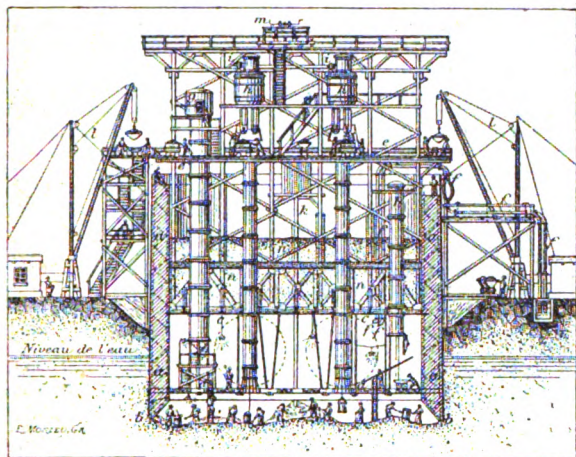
Sezione verticale del pozzo Steinwerder durante il lavoro di affondamento: *a*, rivestimento del pozzo; *b*, estremità di avanzamento del pozzo; *c*, fondo delle casse per la sabbia; *d*, ponte di lavoro; *e*, piccola ferrovia per vagonetti; *f*, condotte d'aria; *g*, camere d'entrata del cassone di lavoro; *h*, camera per detriti; *i*, motori elettrici; *k*, impianto d'aspirazione; *l*, grue; *m*, verricello; *n*, sabbia.
